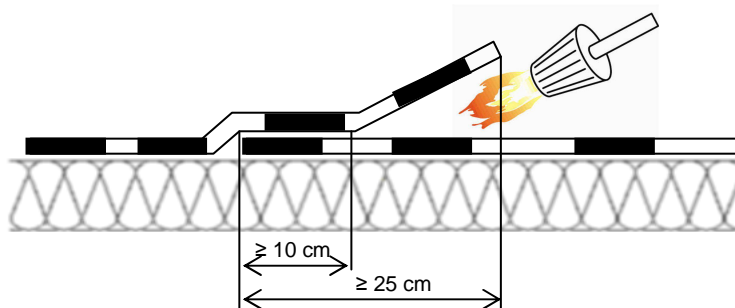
Soudure de l'about de lé sur PSE
